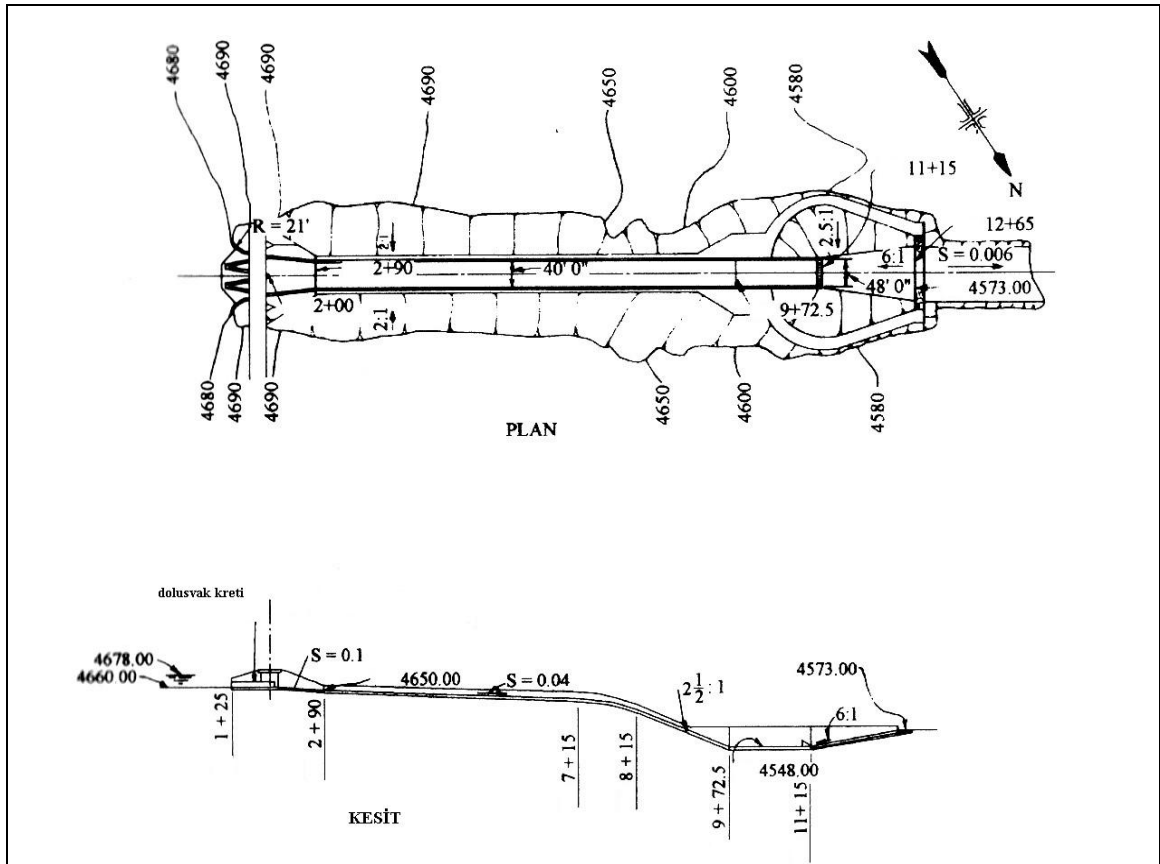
Avon Barajı Labirent Dolusavak Yerleşim Planı ve Savak Detayı [6]
